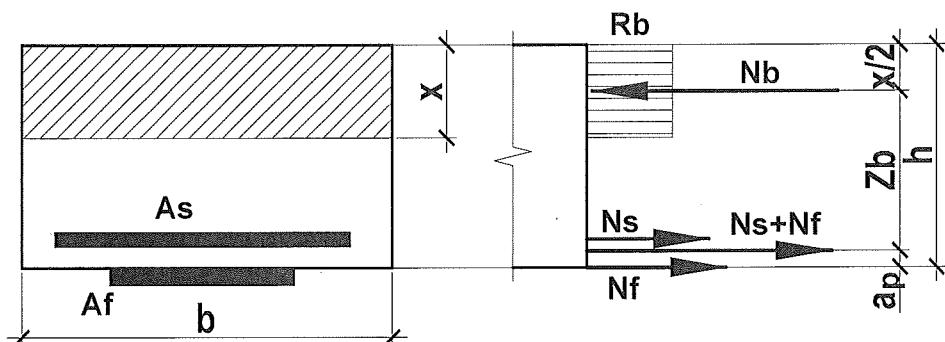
Расчетная схема усиливаемого сечения
